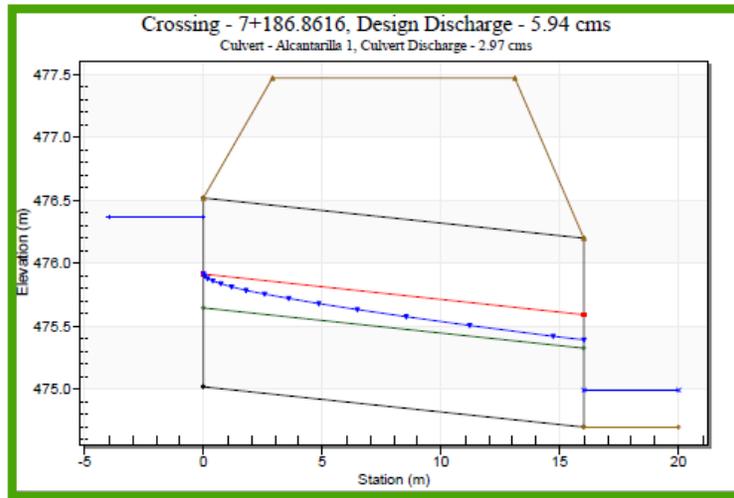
Modelaje de la alcantarilla 7+186.8616
